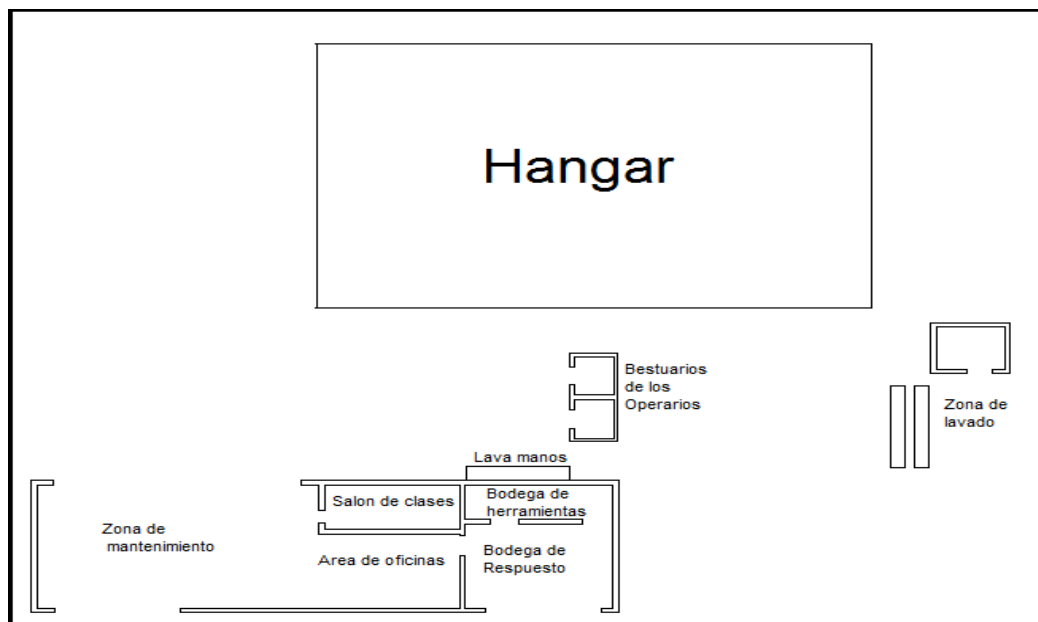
Distribución encontrada al inicio del plan de trabajo
